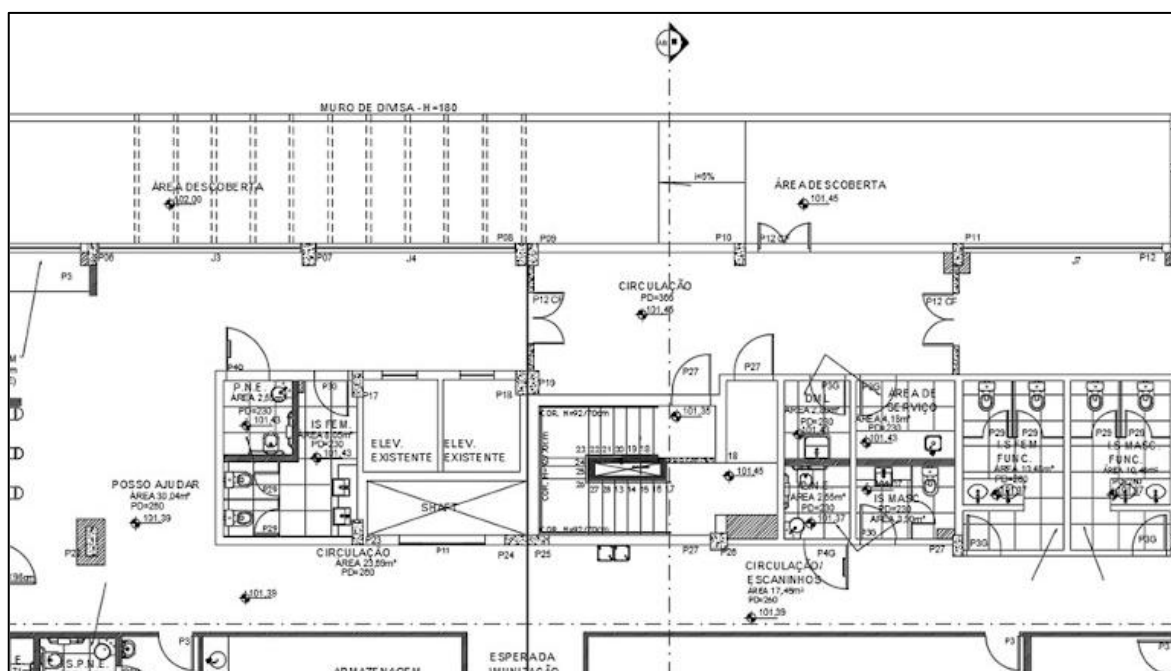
Planta 1º pavimento – proposta de modificações atendimento PPCI.
